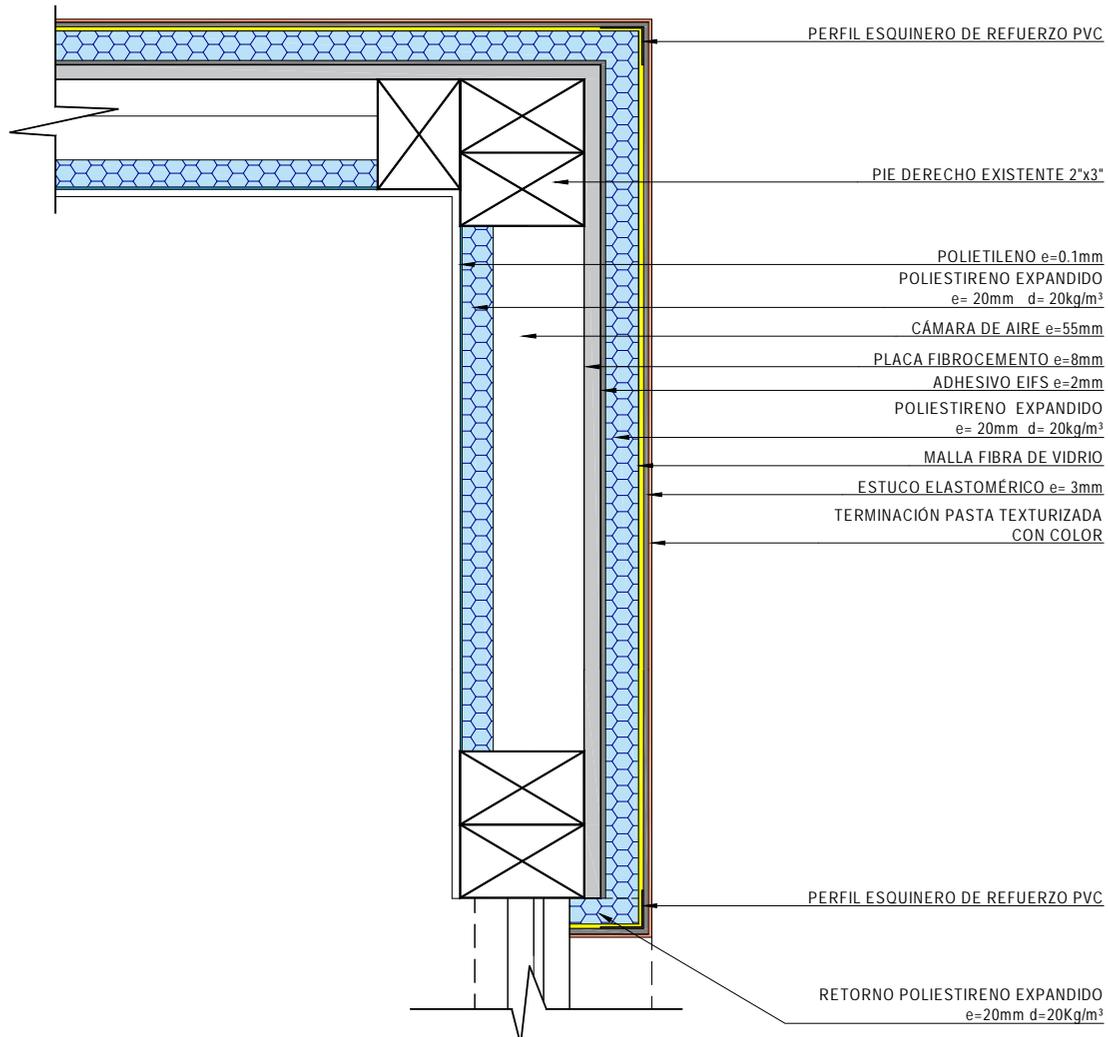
DETALLE INSTALACIÓN MALLAS DE REFUERZO EN VANOS DE VENTANAS Y PUERTAS.
